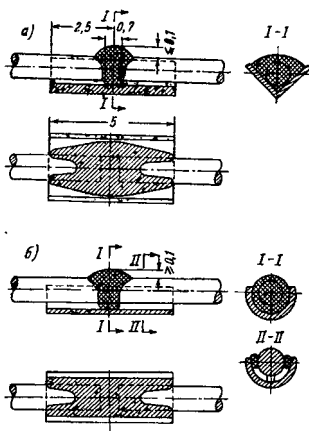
Сварка рабочей арматуры балок "ванным" способом
